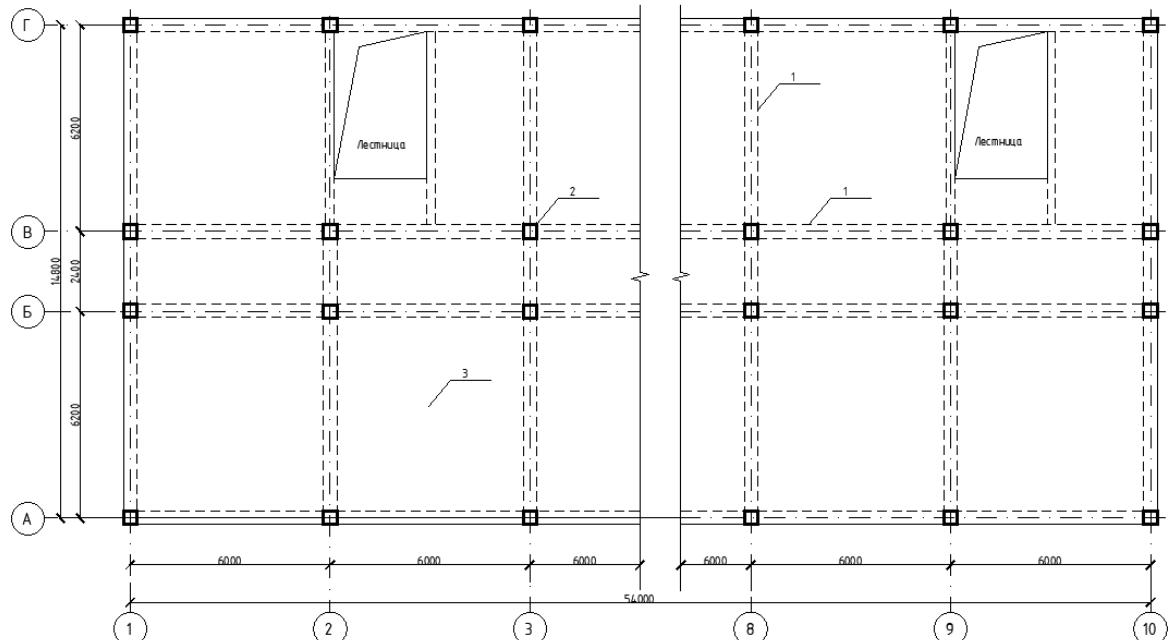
Конструктивная схема монолитного ребристого перекрытия:
